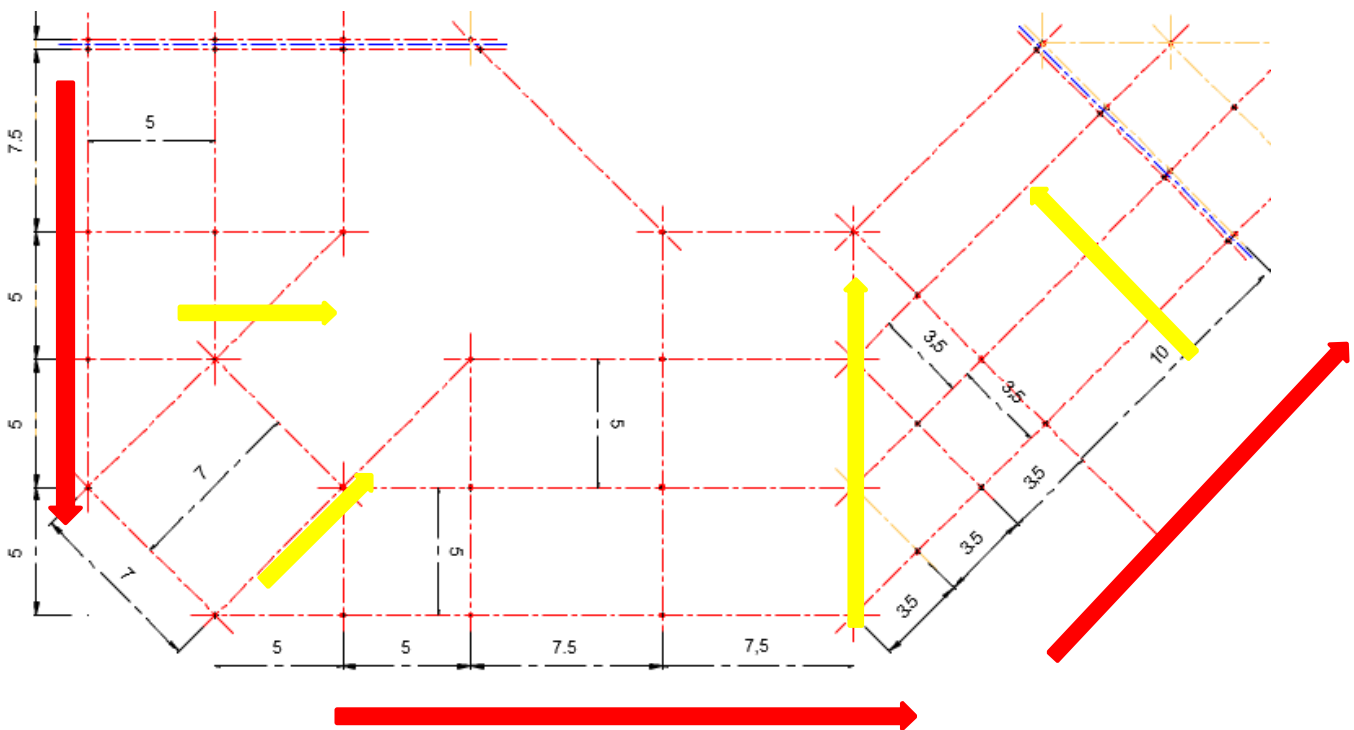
plan de structure de centre communautaire ³⁰³
